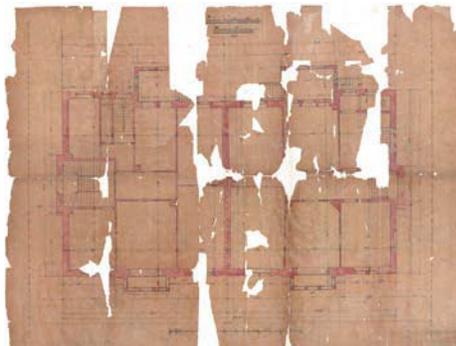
Restaurierter Pergaminplan, Grundriss des Erdgeschosses Jahnstraße 6-8, 1883 (Gustav Ziegler, Stadtarchiv Karlsruhe 8/BOA P 93)
